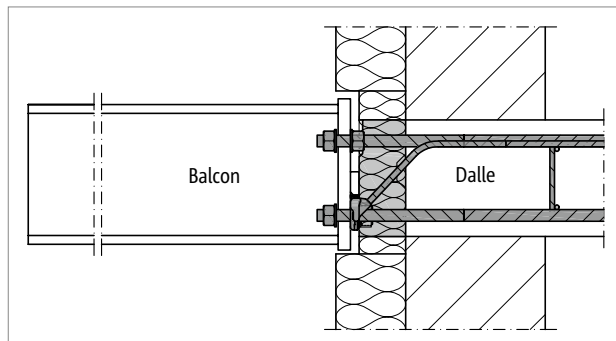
Schöck Isokorb® T type SK : Raccordement à la dalle en béton ; corps isolant à l'intérieur de l'isolation externe
